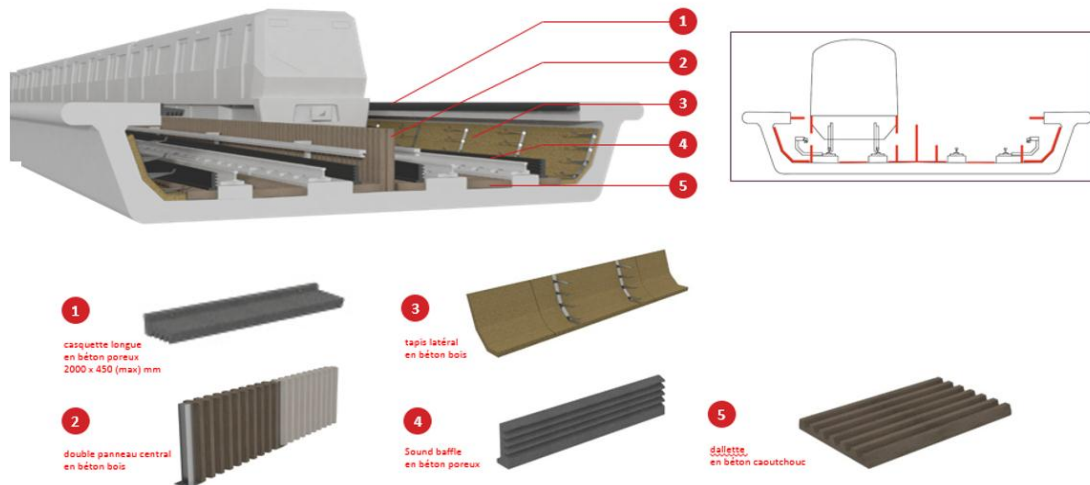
Posible esquema de sistema S-rack en viga gran-U
